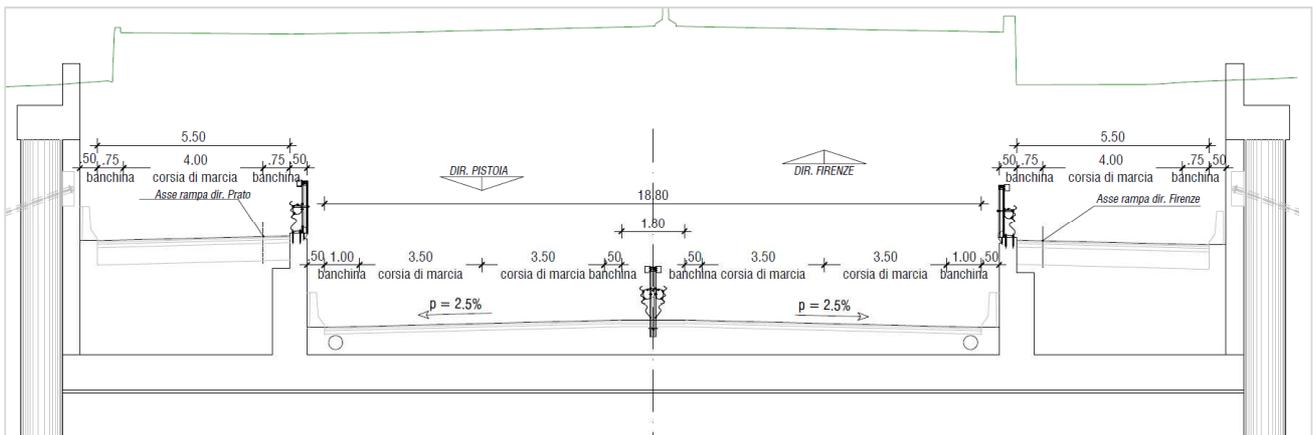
Sezione tipo "ASSE PRINCIPALE CON RAMPE IN AFFIANCAMENTO"
